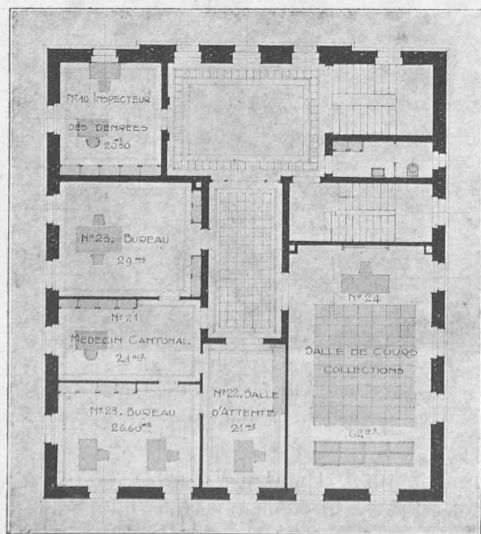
Plan du 1^{er} étage. — 1 : 300.
